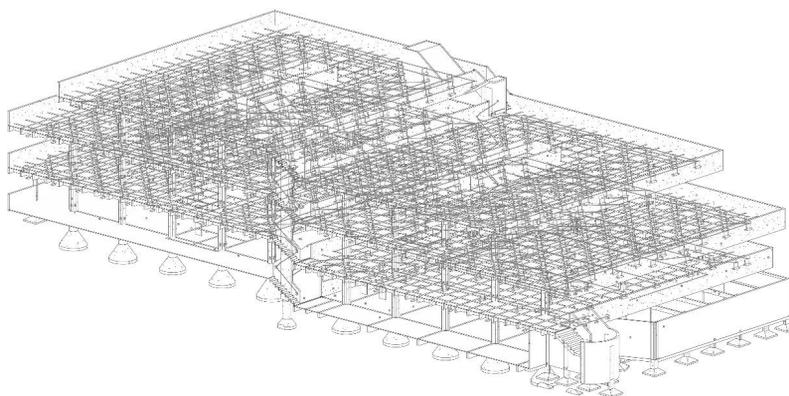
Modelo de Instalações Elétrica BIM. Fonte: elaborado pelo autor
